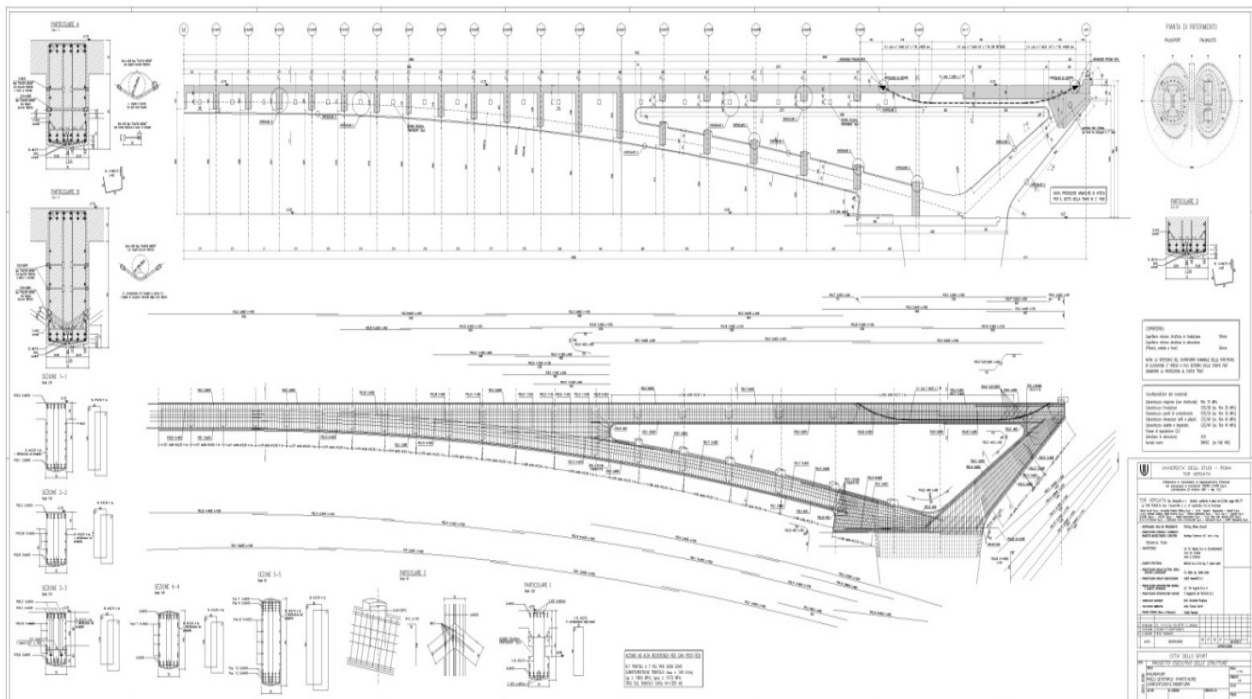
Carpenteria ed armatura dell'arco centrale (parte 1 di 2 simmetriche)
